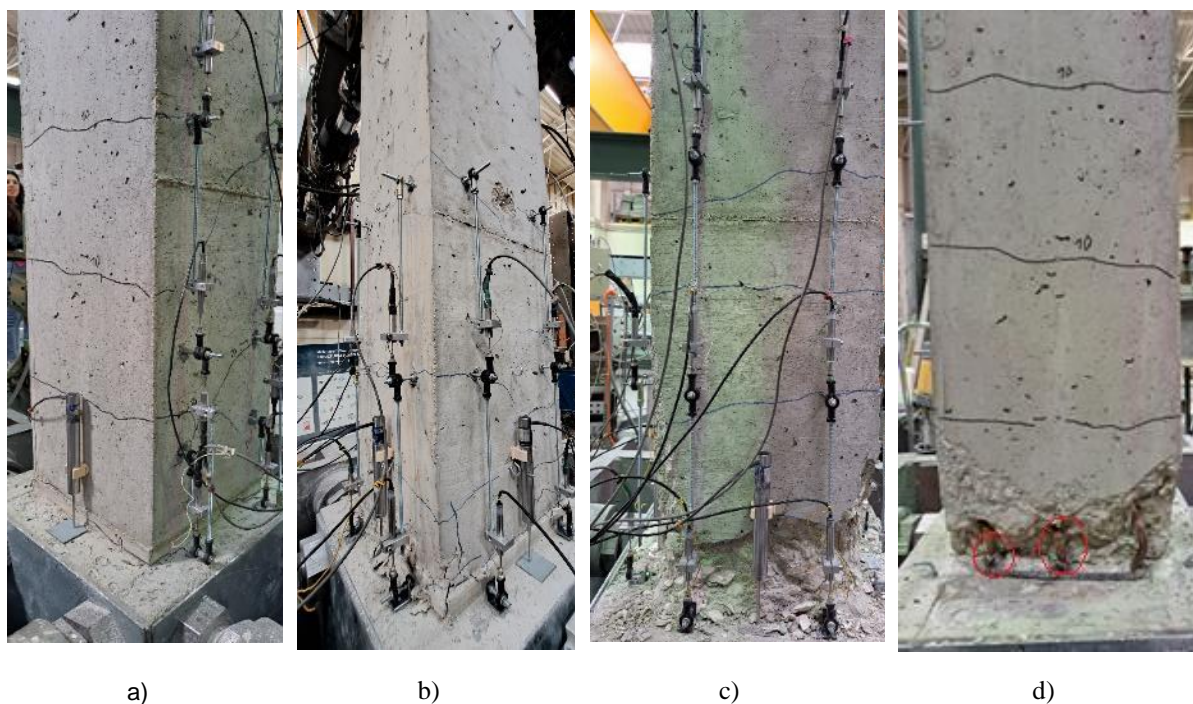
Fases de dano: a) fissuração; b) fragmentação dos cantos; c) destacamento de betão; d) rutura dos varões.
